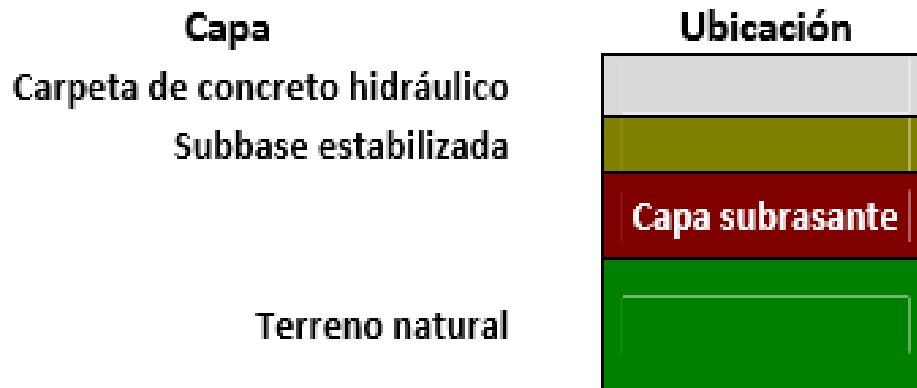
Ubicación de la capa sub-rasante dentro de la estructura del nuevo pavimento.
